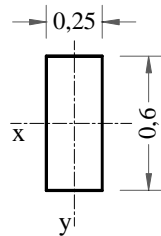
Sección de la viga V1. Las Medidas están dadas en Metros
